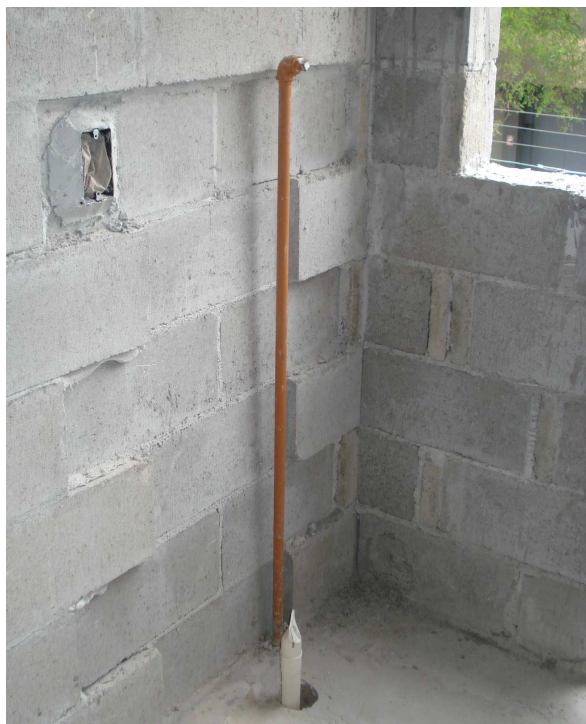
Reentrância na parede para embutir instalações. Fonte: Foto do autor.
